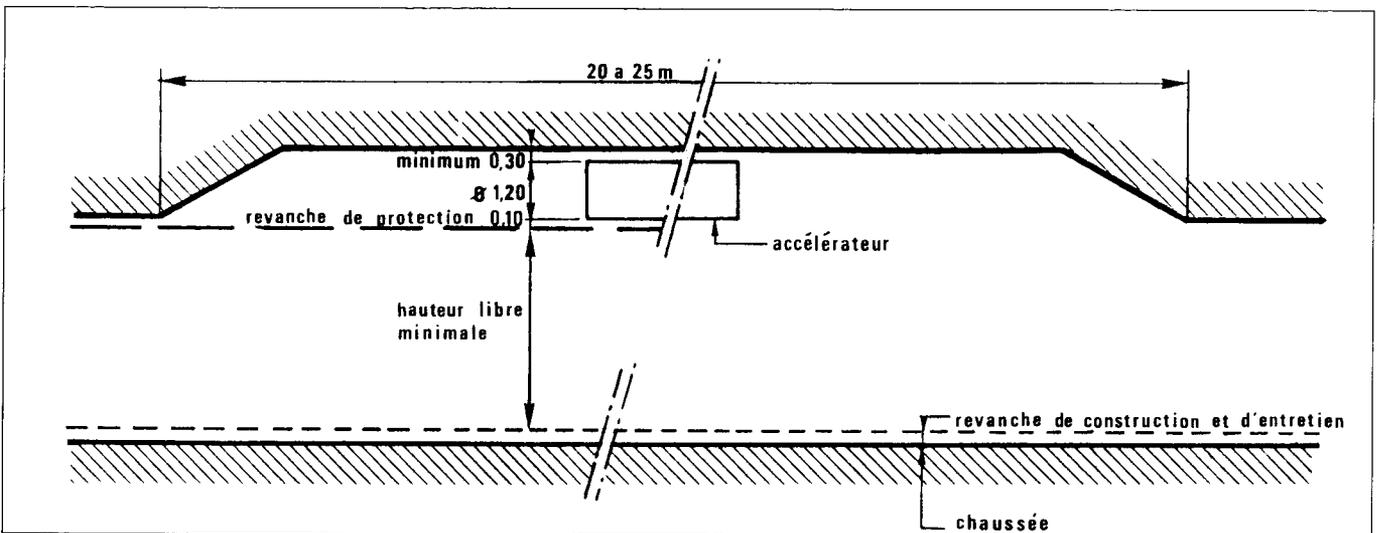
Coupe au droit d'une niche de ventilation
